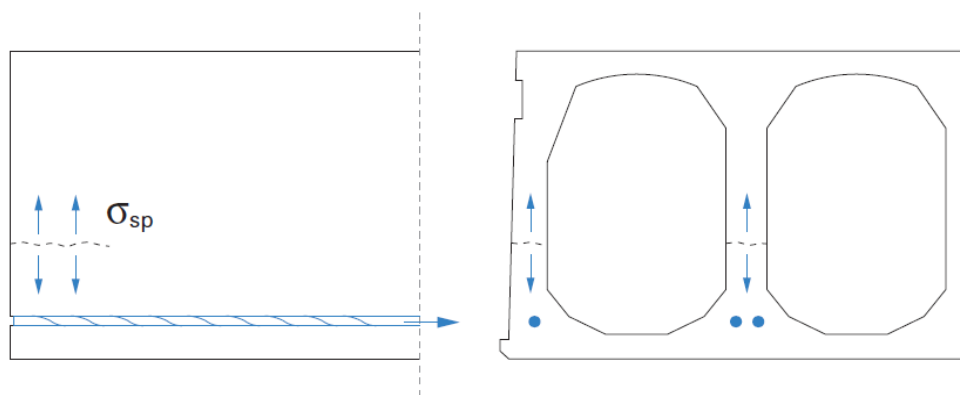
Fissuras típicas de destacamento da alma *spalling
